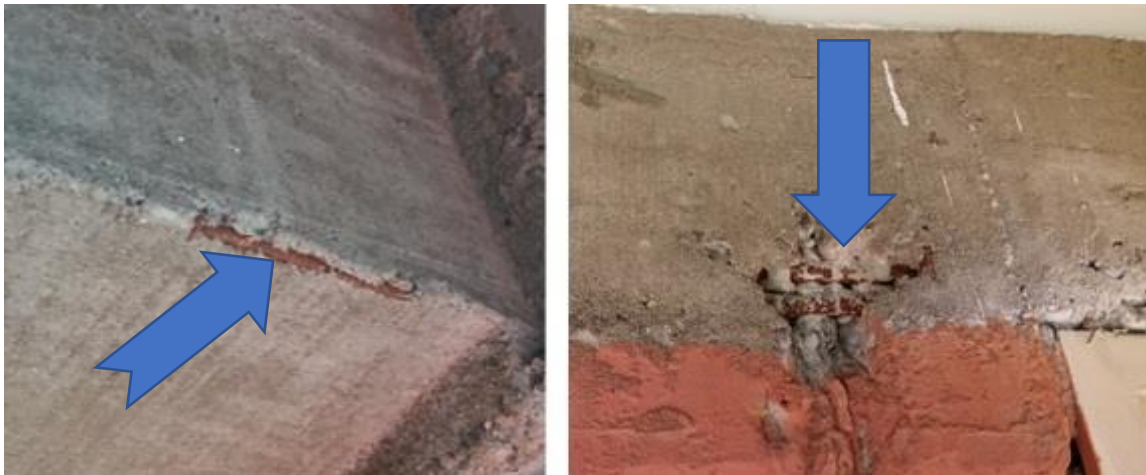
Hierro corroído en vigas Fuente Propia
